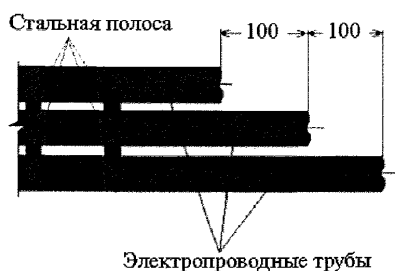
Размещение электропроводных труб в блоке соединяемых труб
